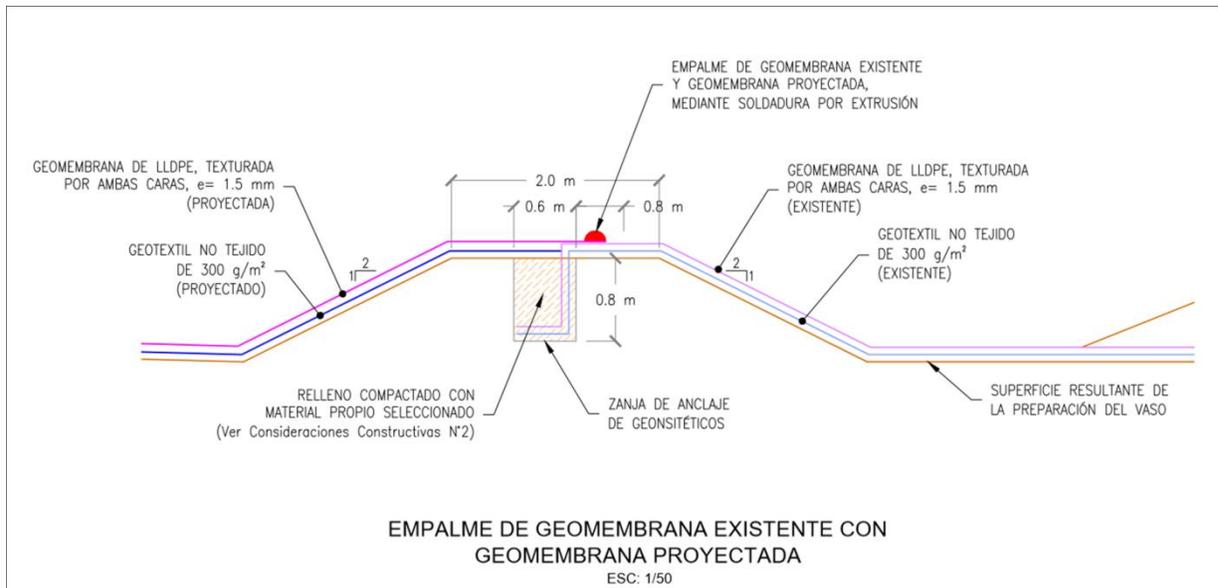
16. Impermeabilizado con fusión a cubierta existente
